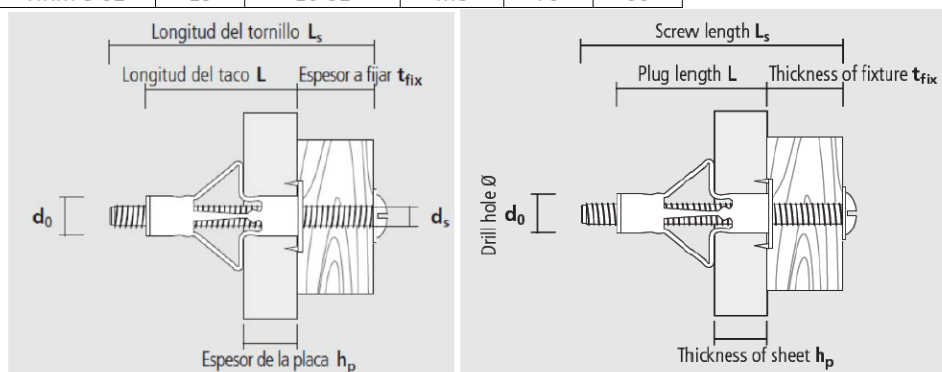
Fixation de l'équipement sur un mur de maçonnerie conventionnel
